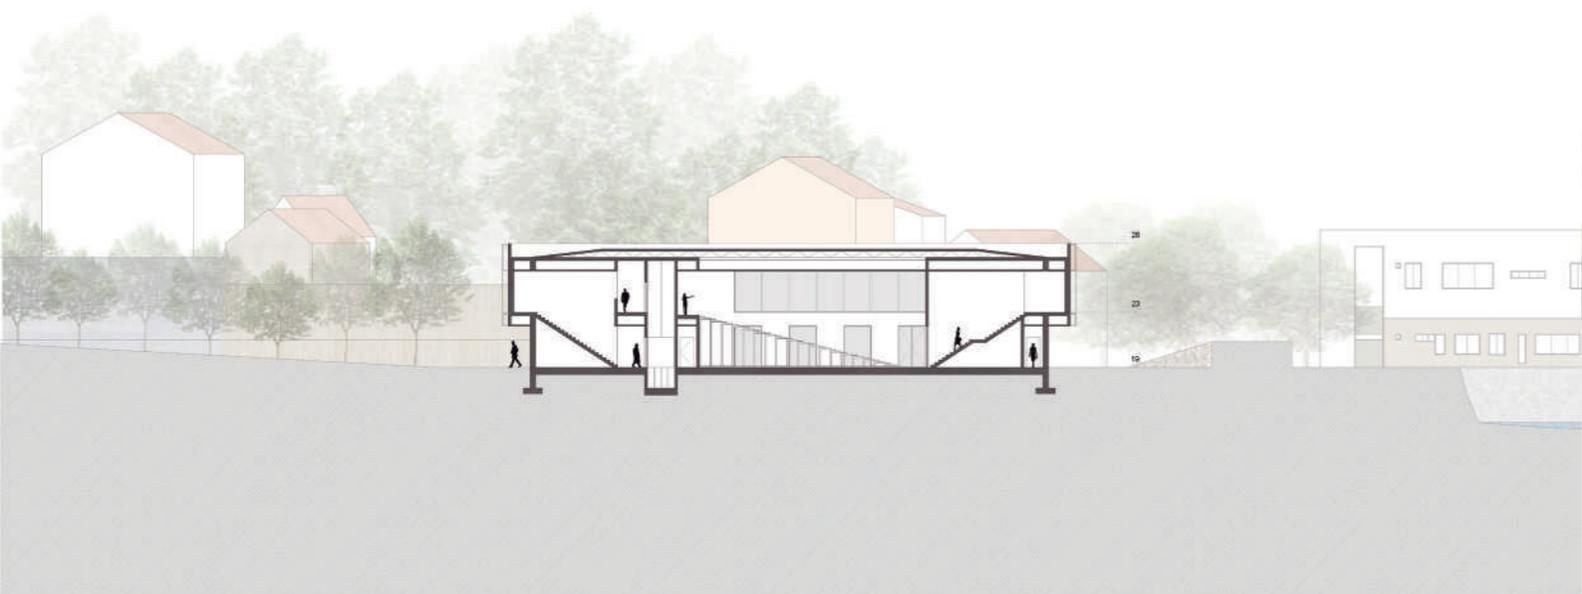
Corte Longitudinal E-E' (redução da escala 1:200)
